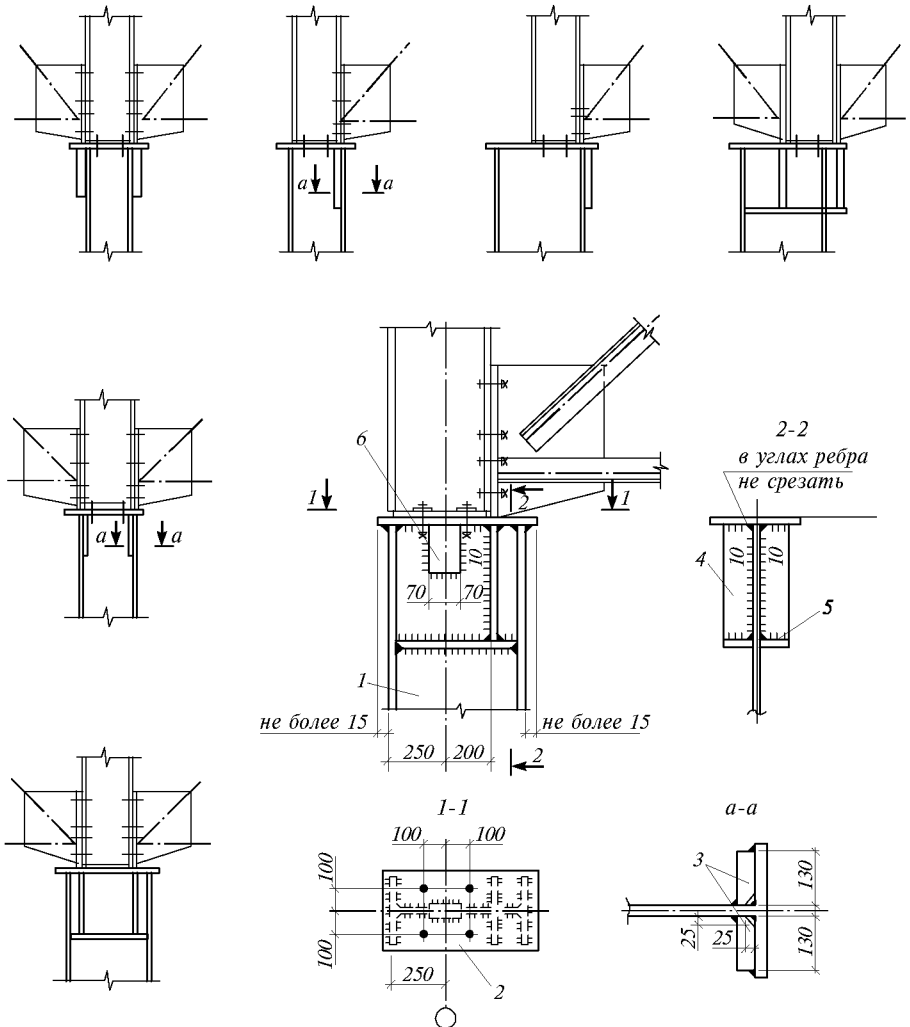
Узел шарнирного опирания стропильной фермы на колонну и варианты его технических решений
